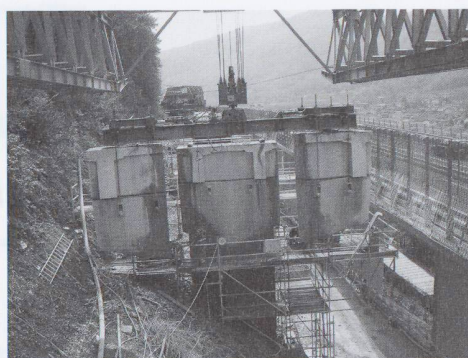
Rimozione delle travi trasversali e di testa pila (pulvini)
